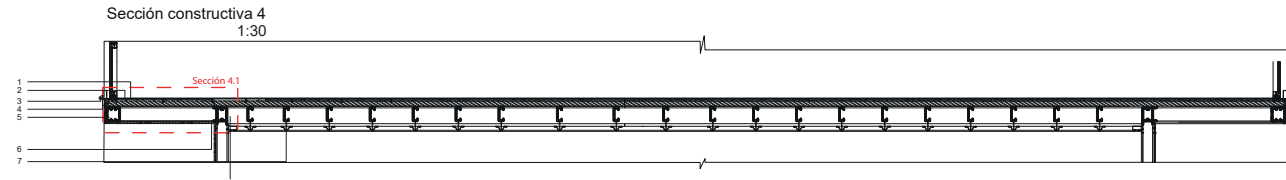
Modelado detalle constructivo 3 entramado cubierta
